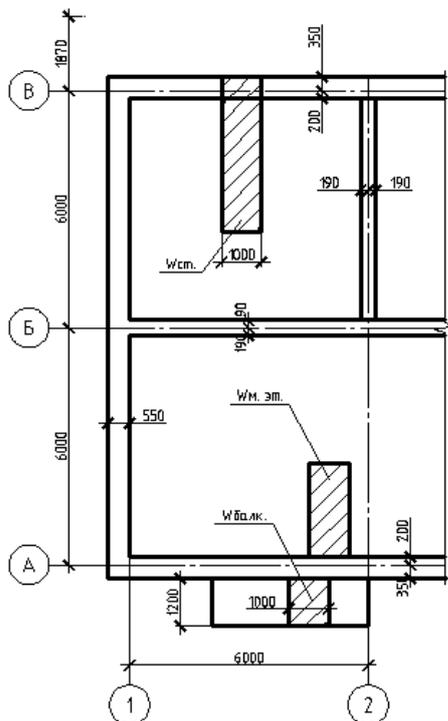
Грузовая площадь стены после реконструкции
